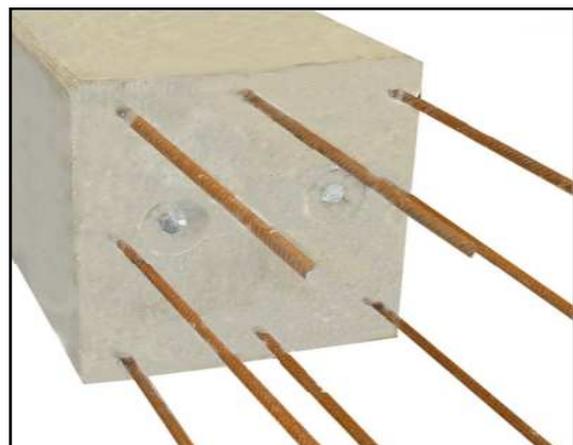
Béton armé source : <http://www.le-beton.fr>
